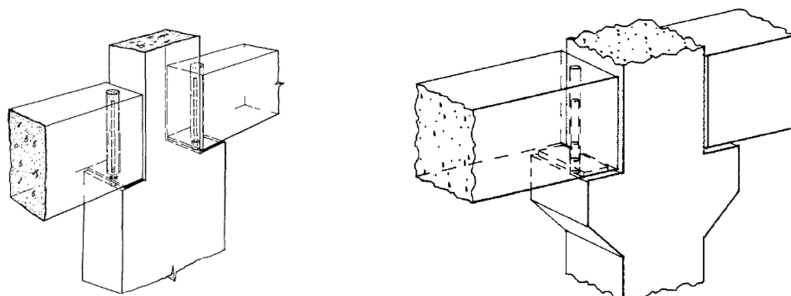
Exemplos de ligação viga-pilar sem continuidade, directamente sobre o pilar (esquerda) e assente sobre consola curta (direita). Adaptado de [1].
